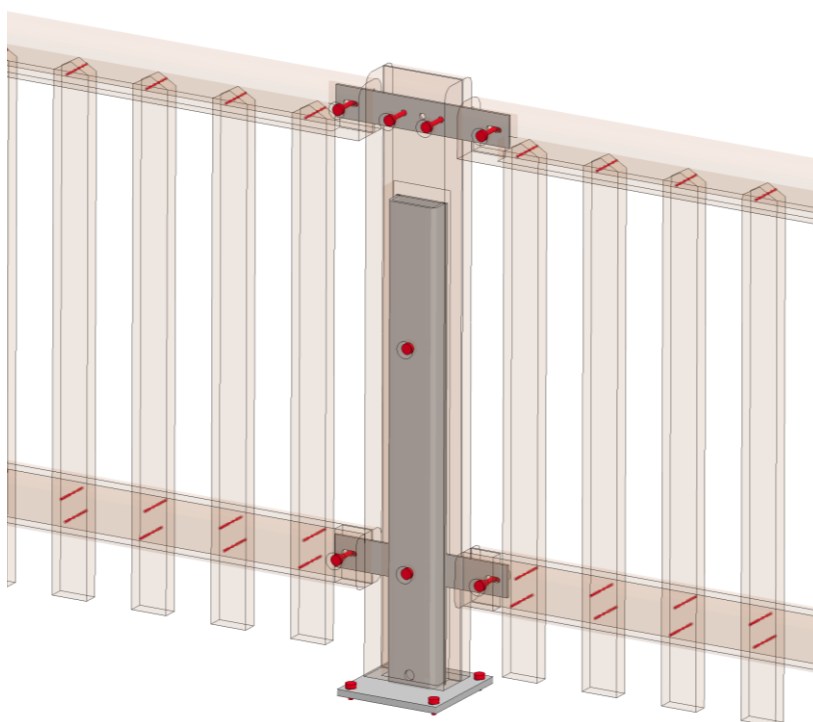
Modello ad elementi finiti del parapetto – Dettaglio collegamenti
